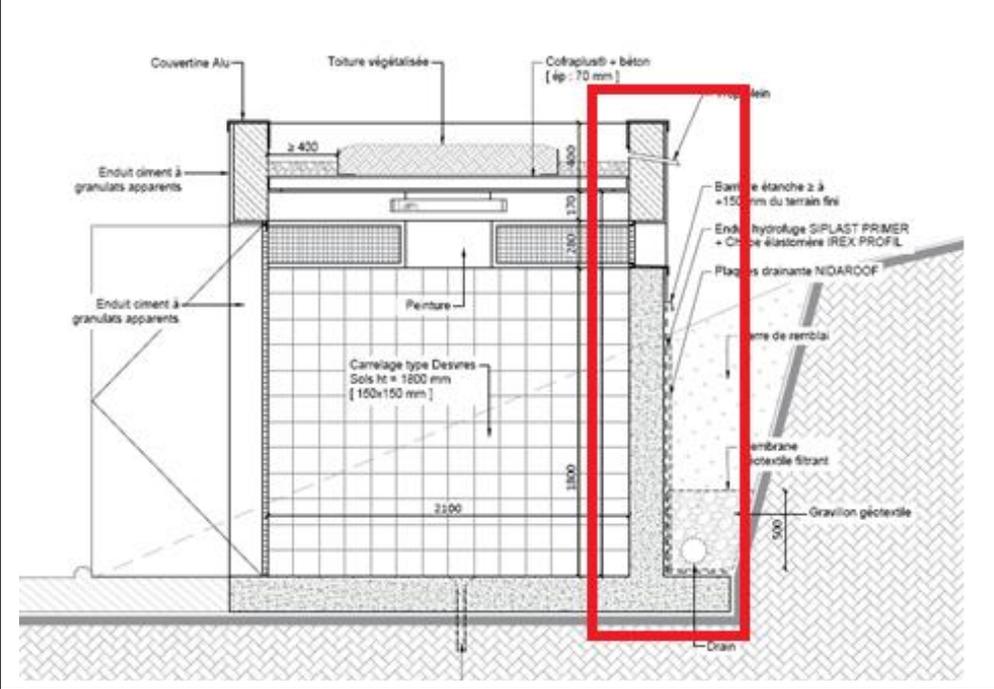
EXTRAIT PLAN ARCHITECTURE (COUPE).
